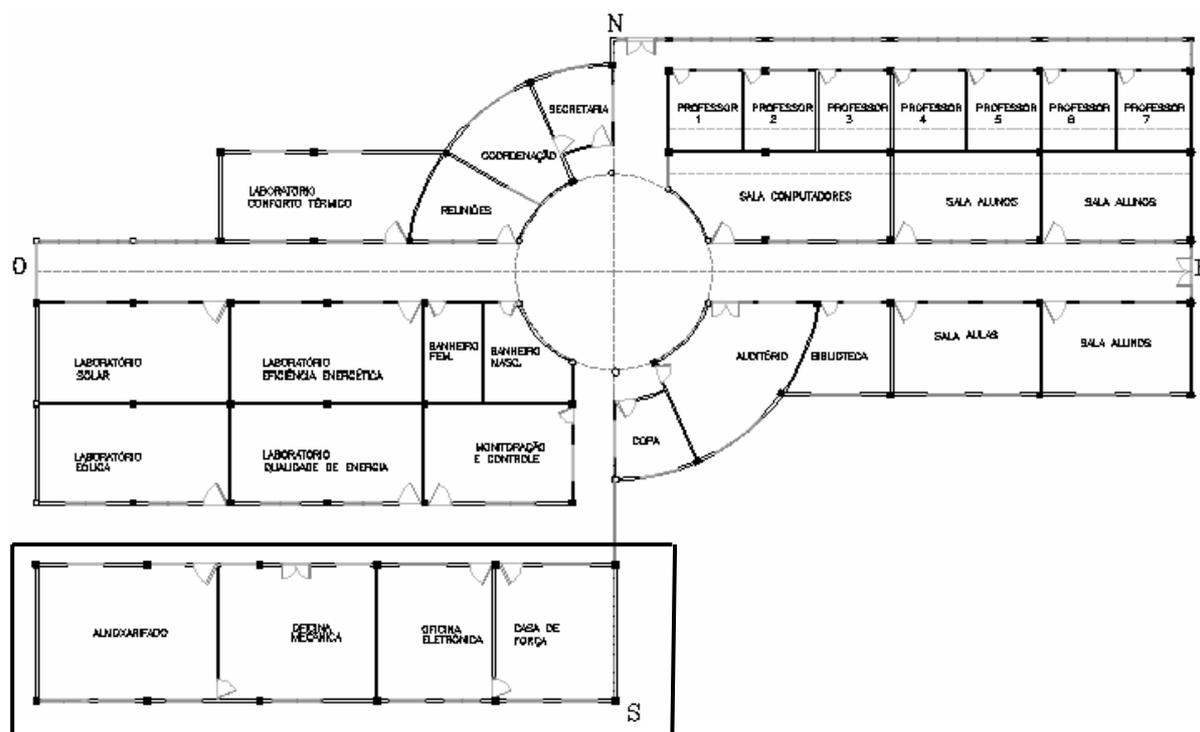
Planta baixa. Destaca-se a área já construída.
